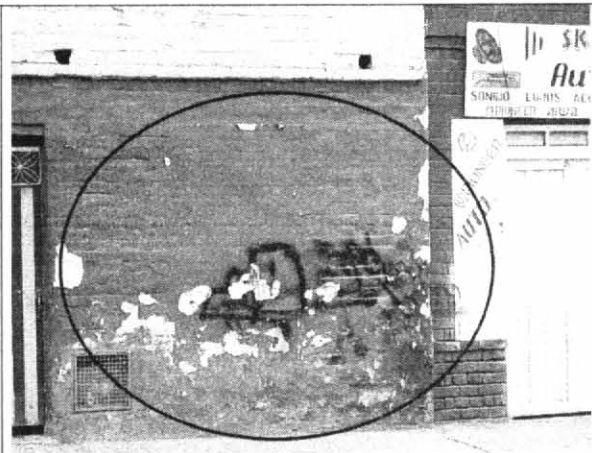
Desprendimiento de acabados en la fachada del inmueble.
